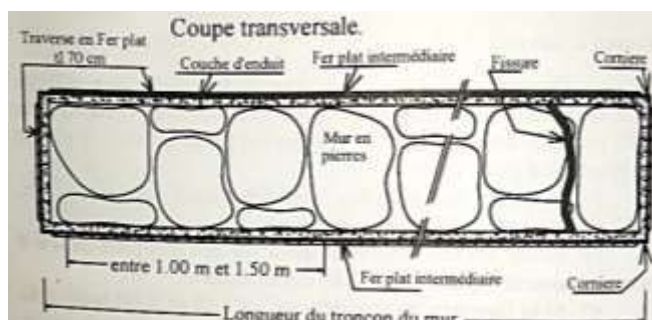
65 : coupe illustrant le Gainage d'un tronçon d'un mur (vue d'angle)
